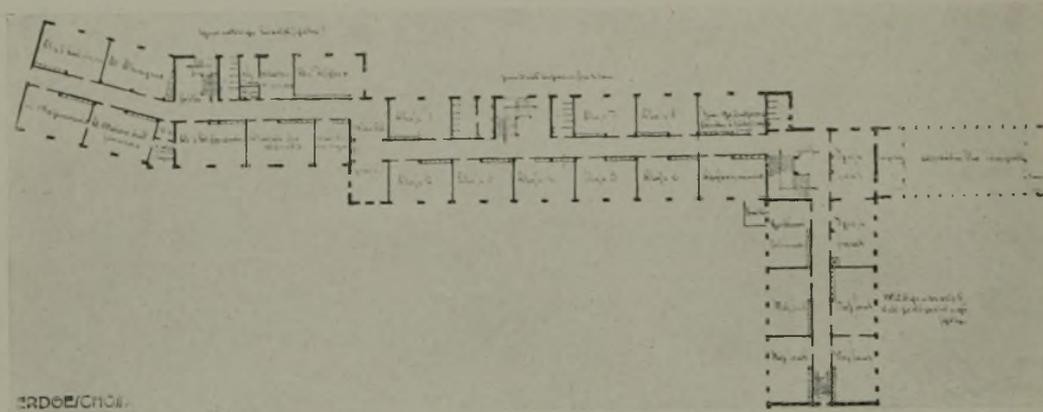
(Mitte). Grundriß Erdgeschoß.
